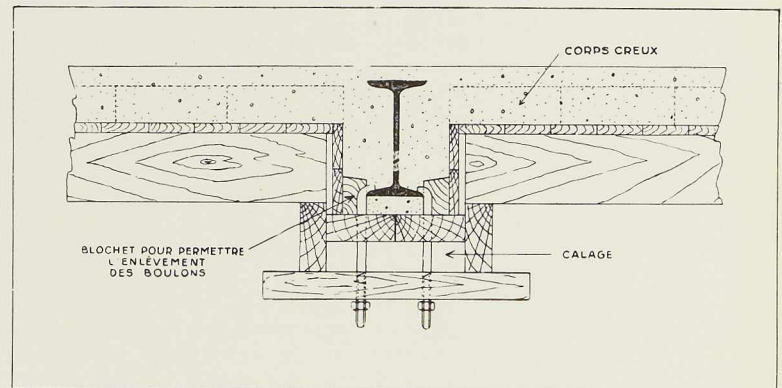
Le coffrage du hourdis peut être entièrement suspendu aux poutrelles métalliques et ne nécessite aucun étaçonnage.
